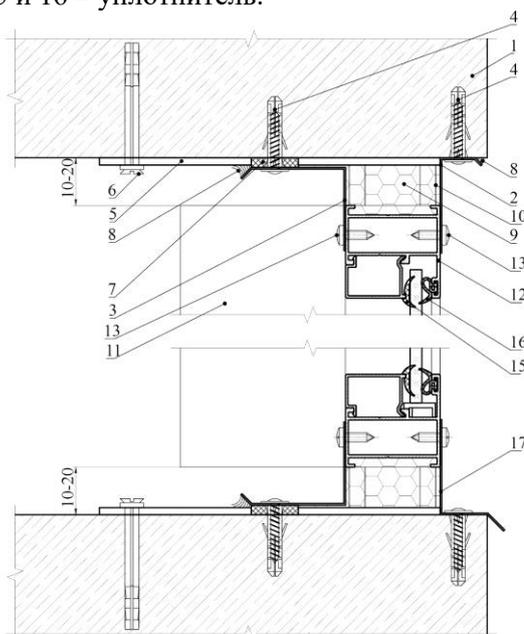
Примыкание витража при установке в проем между плитами перекрытия (каталог витражных конструкций системы Татпроф)
